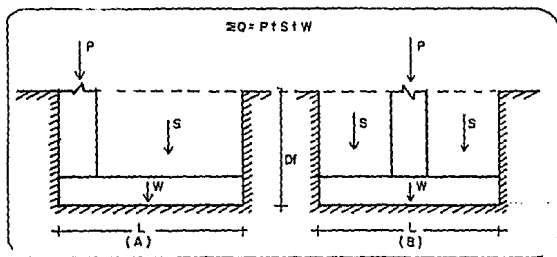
FUERZAS VERTICALES A CONSIDERAR EN LAS ZAPATAS AISLADAS
